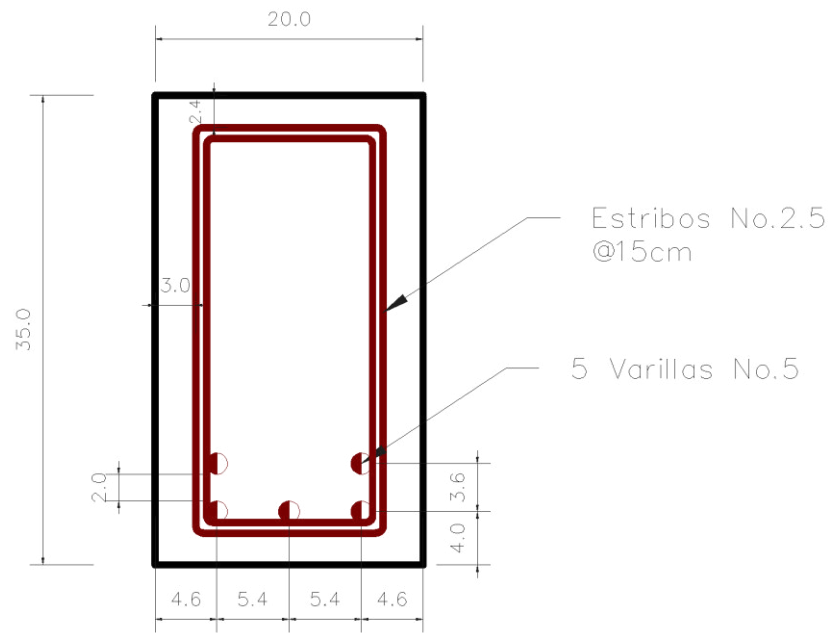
Detalle del acero de refuerzo en la sección transversal de la viga (acotaciones en cm).
